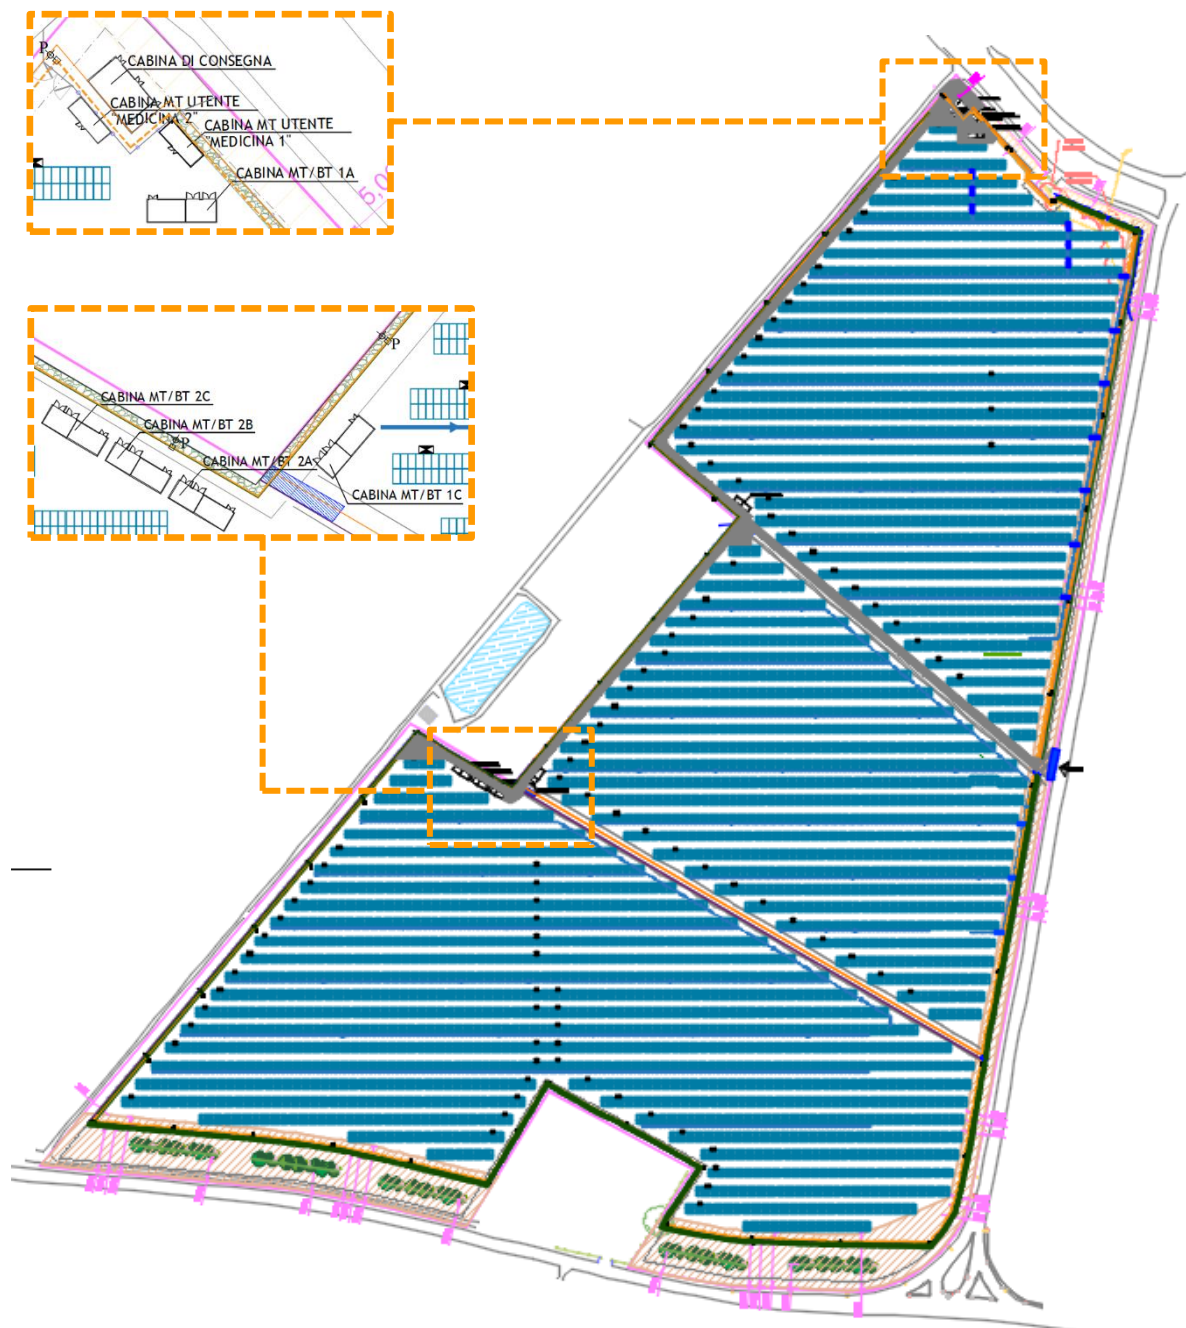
Layout dell'impianto fotovoltaico in progetto
